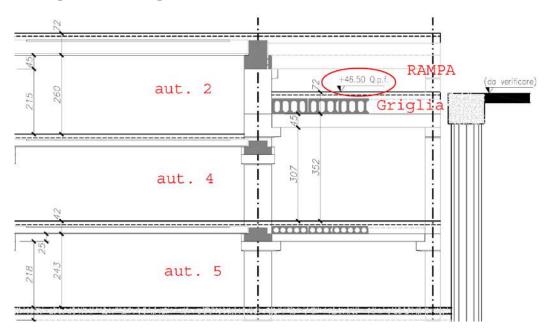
Stralcio di sezione ortogonale alla rampa lato Villa Paola
